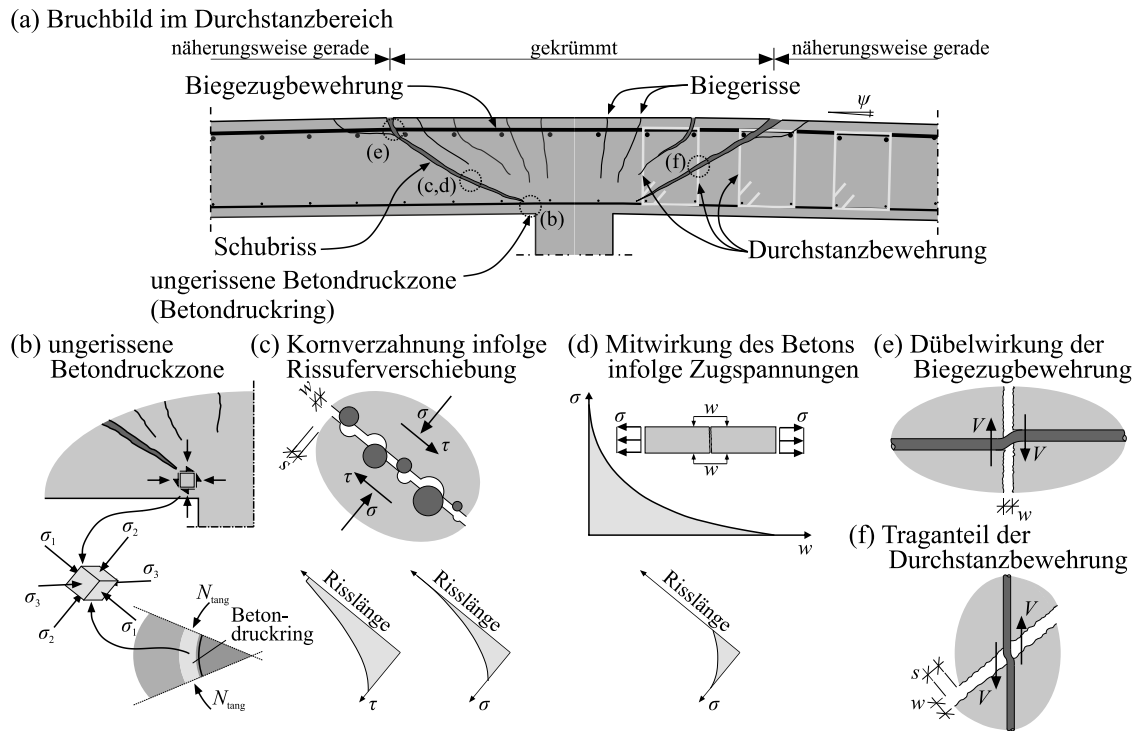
Schubübertragungsmechanismen einer Stahlbetonflachdecke im Bereich des Decke-Stütze-Knotens: (a) typisches Bruchbild eines Durchstanzversagens, (b) Beitrag der ungerissenen Betondruckzone, (c) Kornverzahnung der Rissuferverschiebung, (d) Mitwirkung des Betons auf Zug, (e) Dübelwirkung der Biegezugbewehrung, (f) Traganteil einer Durchstanzbewehrung, entnommen und modifiziert aus [145]
